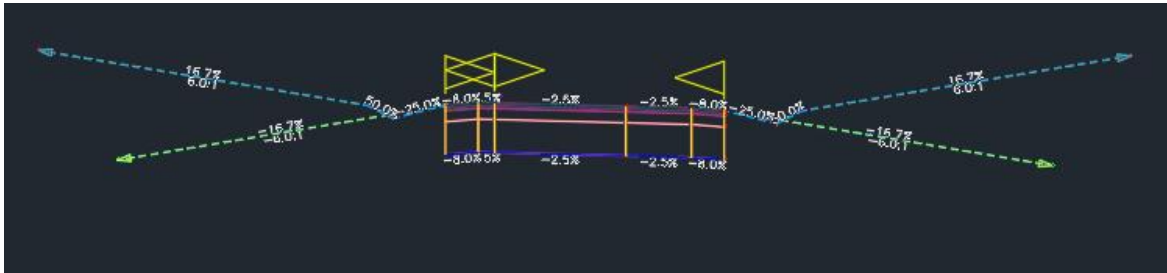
profil en travers type de la bretelle unidirectionnelle
